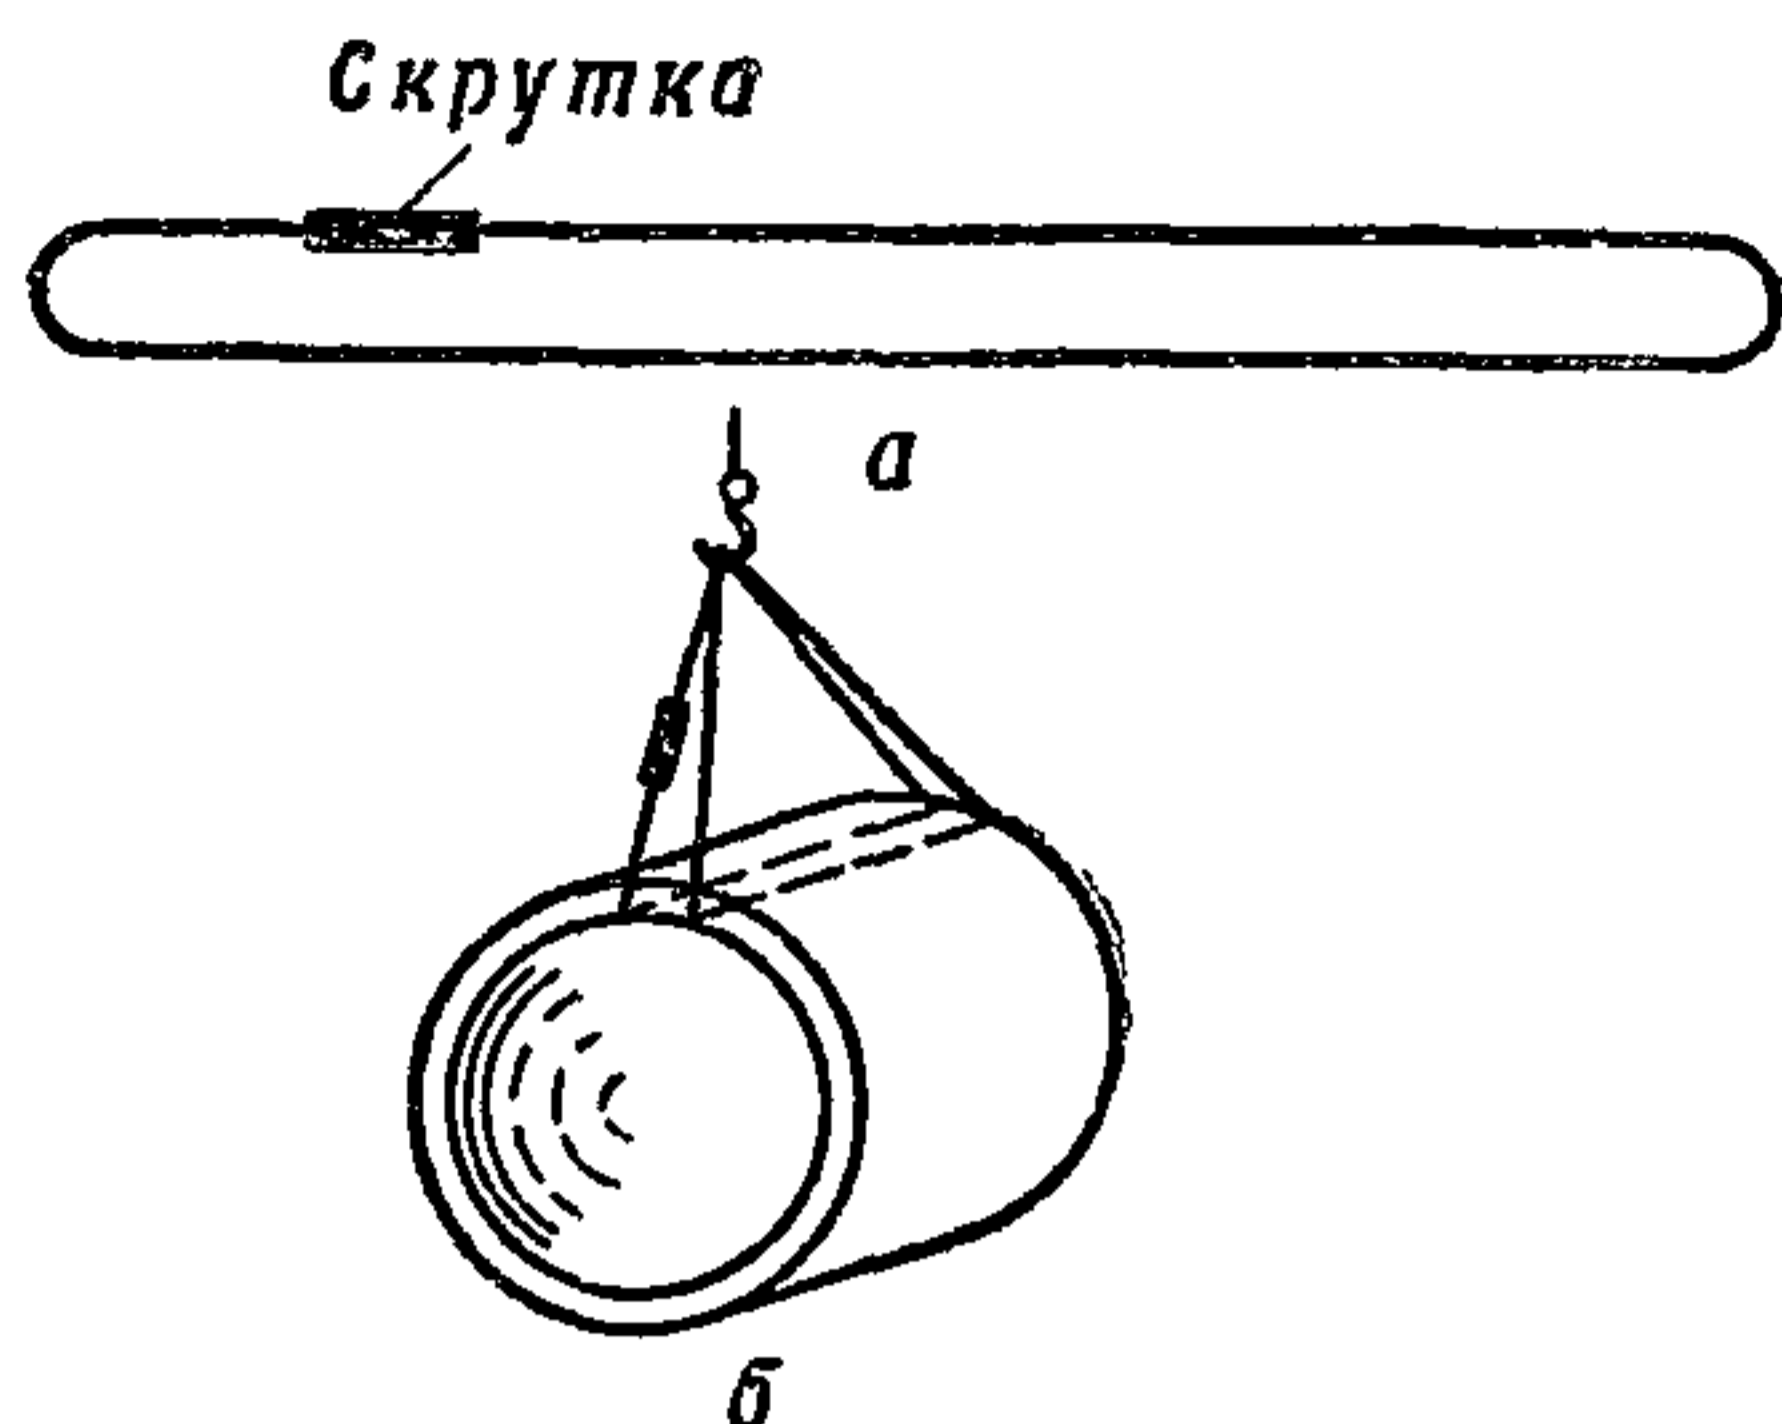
Универсальный строп из троса (а) и схема строповки элемента из железобетонных колец (б)
